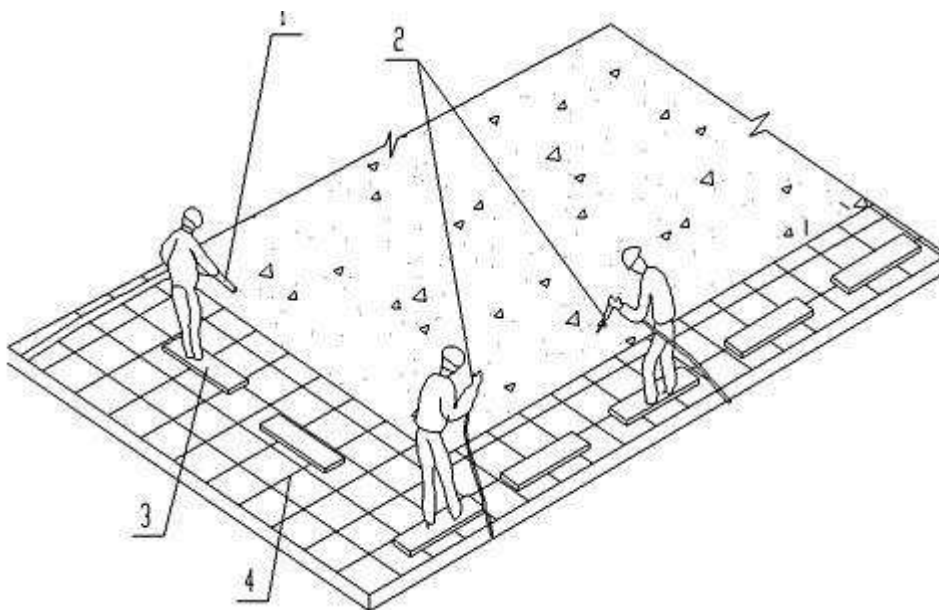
Схема организации рабочего места при бетонировании плиты перекрытия
